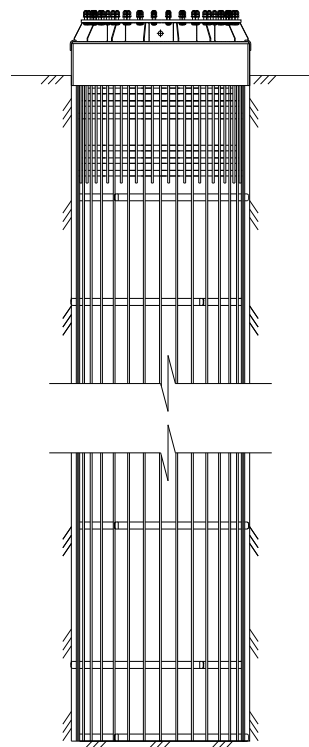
Фундамент из буронабивной сваи. Схема установки.
